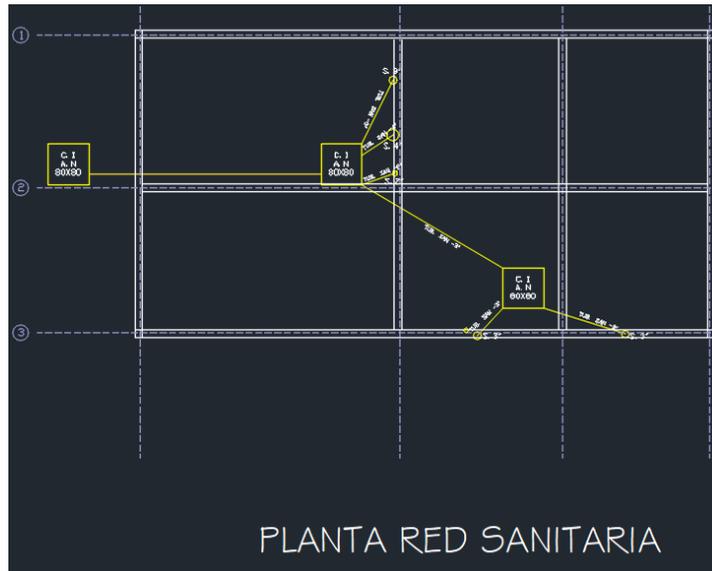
Plano red Sanitaria Fuente: Elaboración propia
